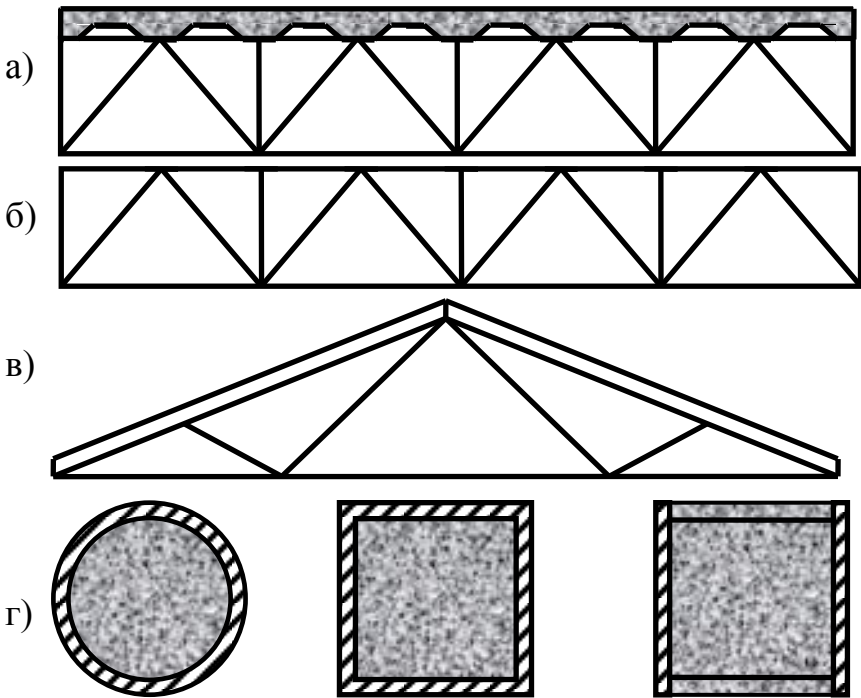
Схеми сталезалізобетонних ферм:
